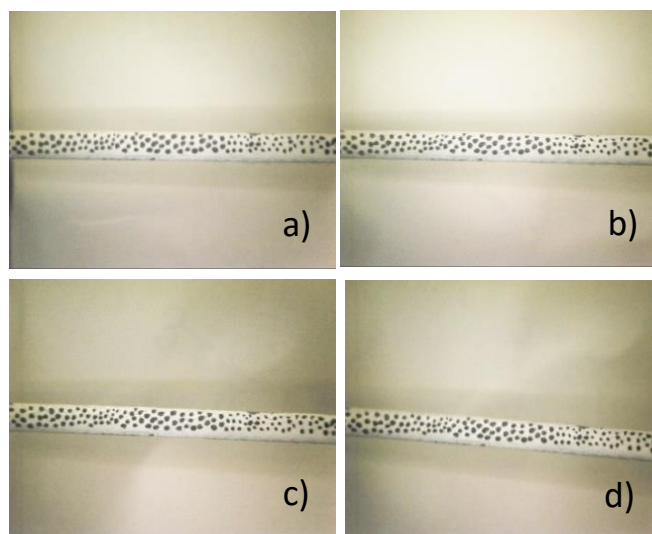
Viga de aço com pontos pequenos e próximos. a) imagem de referência; b) viga com carregamento de 1Kg; c) viga com carregamento de 2kg; d) viga com carregamento de 5kg
